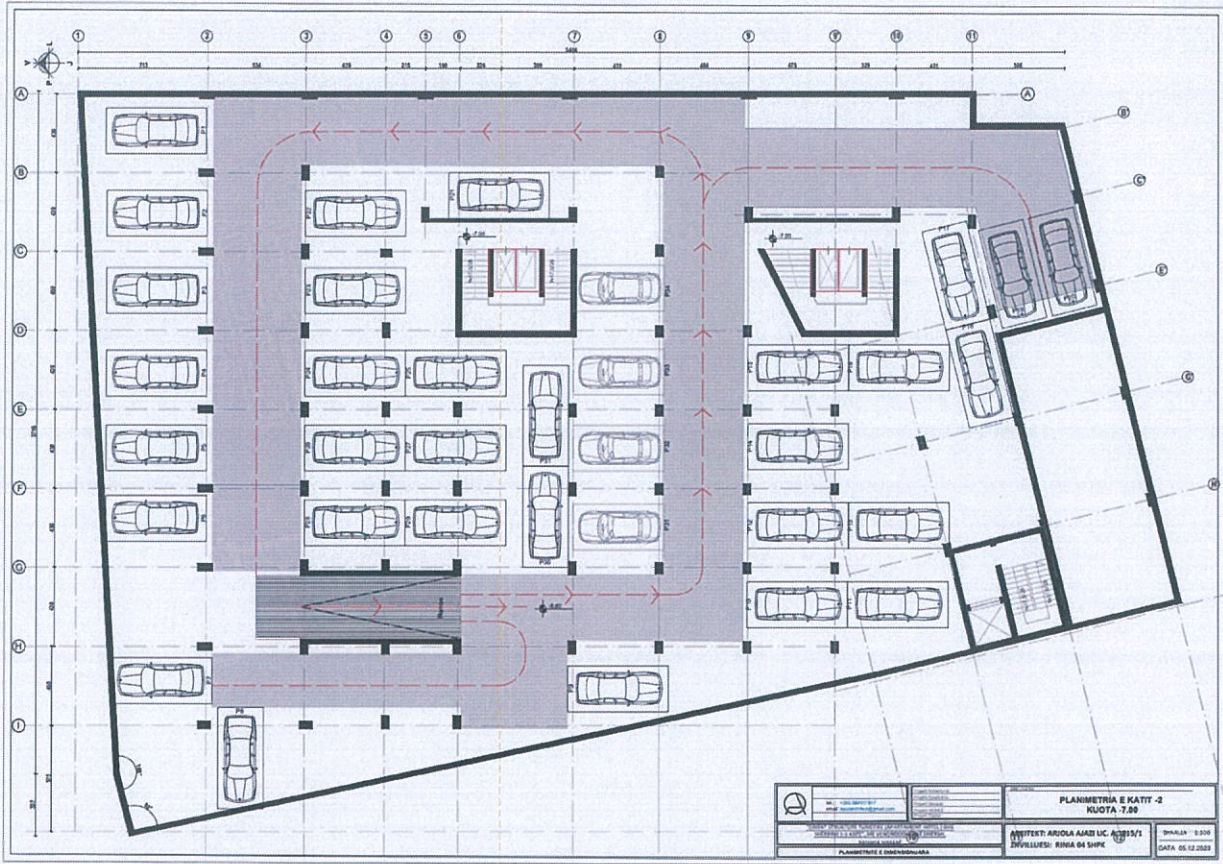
Planimetri e katit nentoke (kuota – 7.00)
